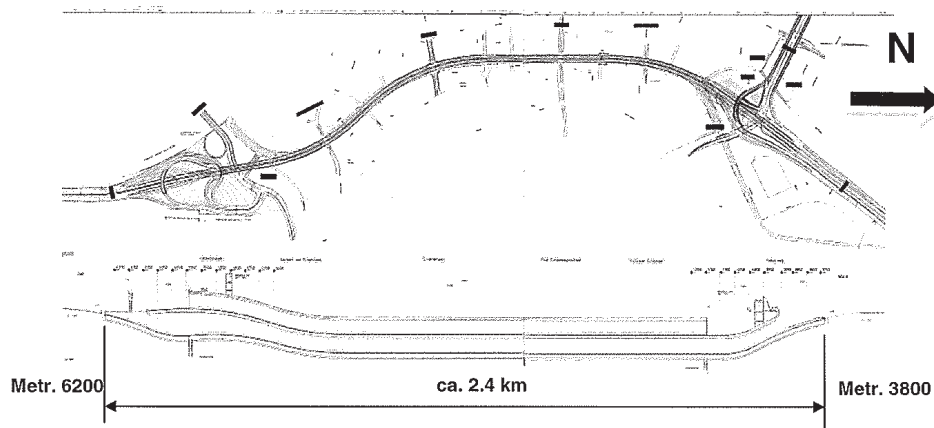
Grundriss und Längsschnitt des Tunnelbauwerks [U 9]
